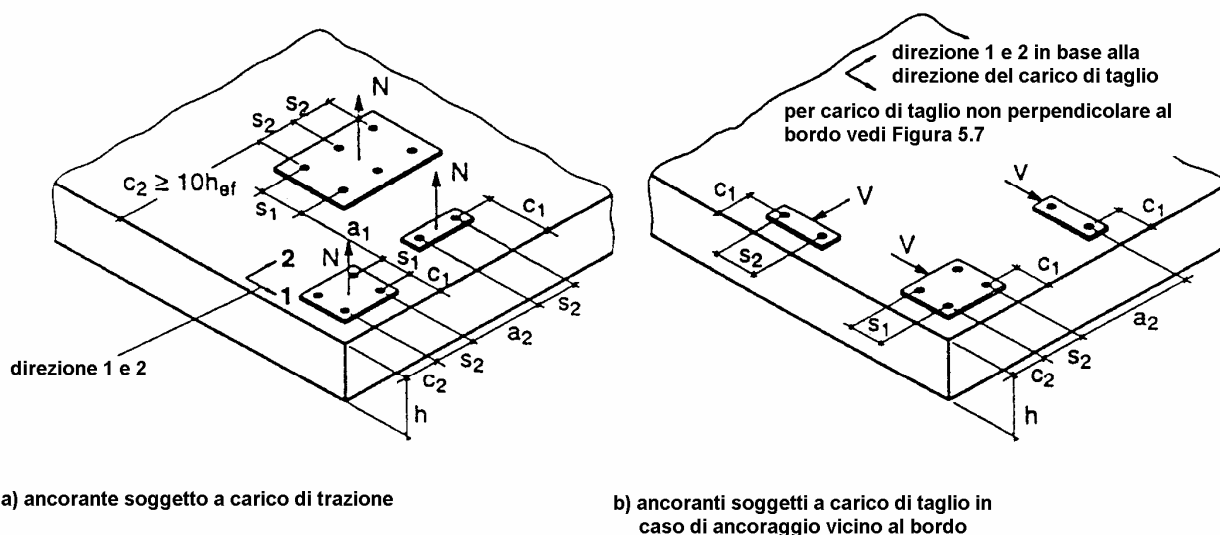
Elemento in calcestruzzo, interasse dell'ancorante e distanza dal bordo.
